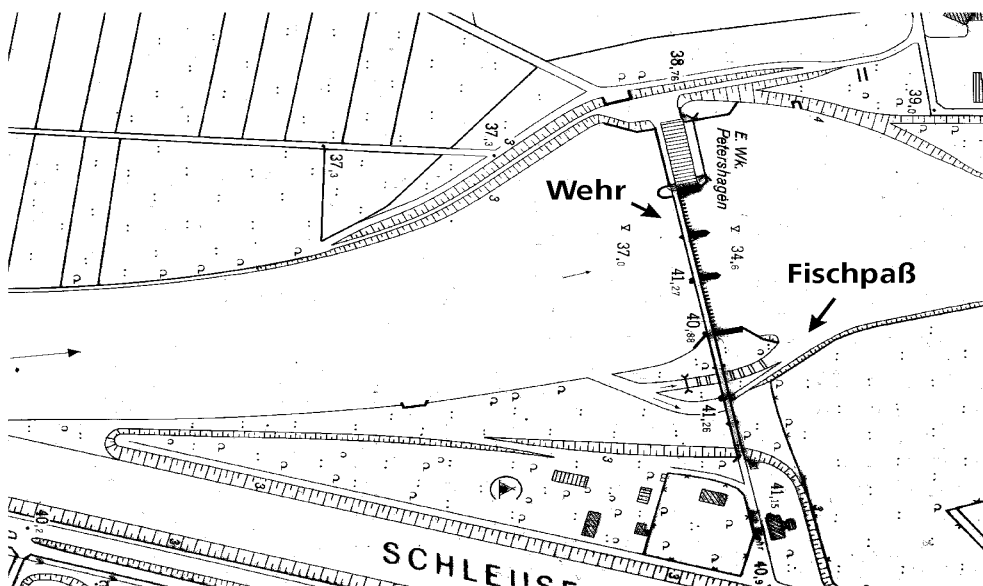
Lageplan der Wehranlage Petershagen
